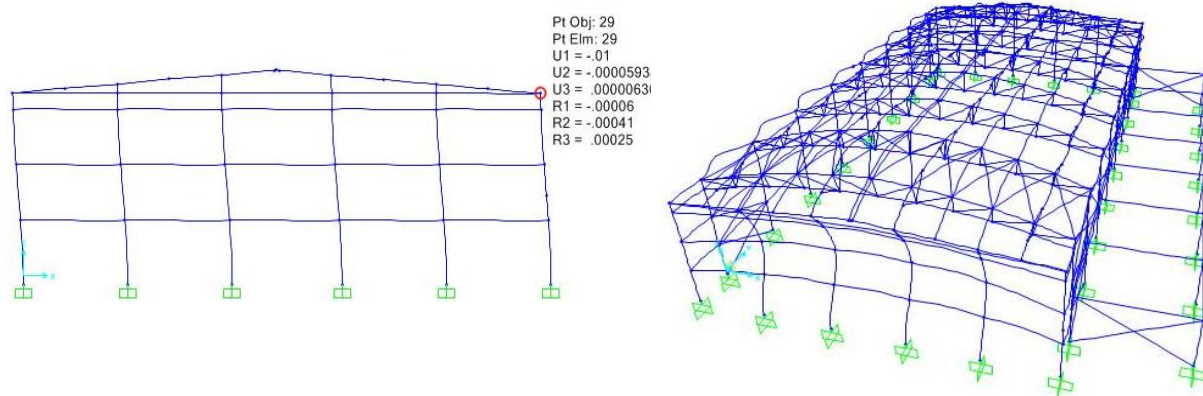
Deformada de la estructura bajo la acción del viento Vy1 (SAP2000).
